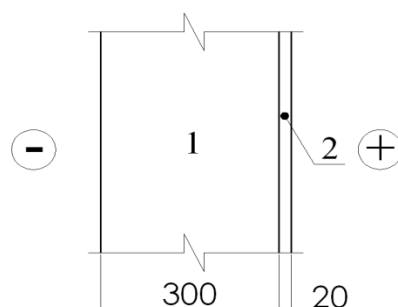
Конструктивная схема наружной стены для производственного здания без утеплителя
